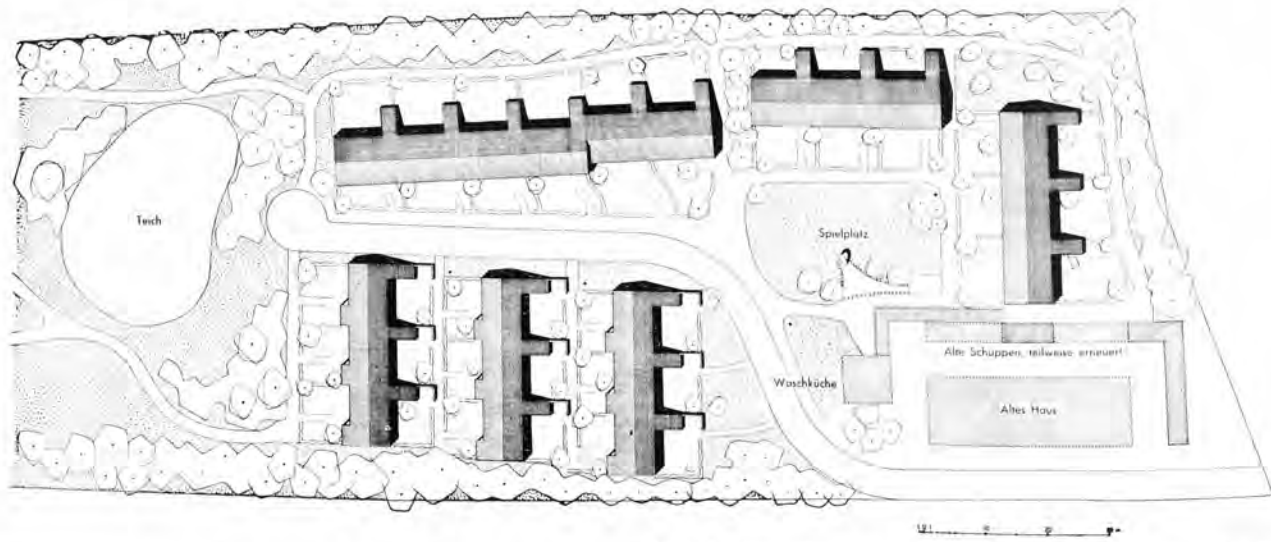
Lageplan der ausgeführten Siedlung. Maßstab 1:1250.
